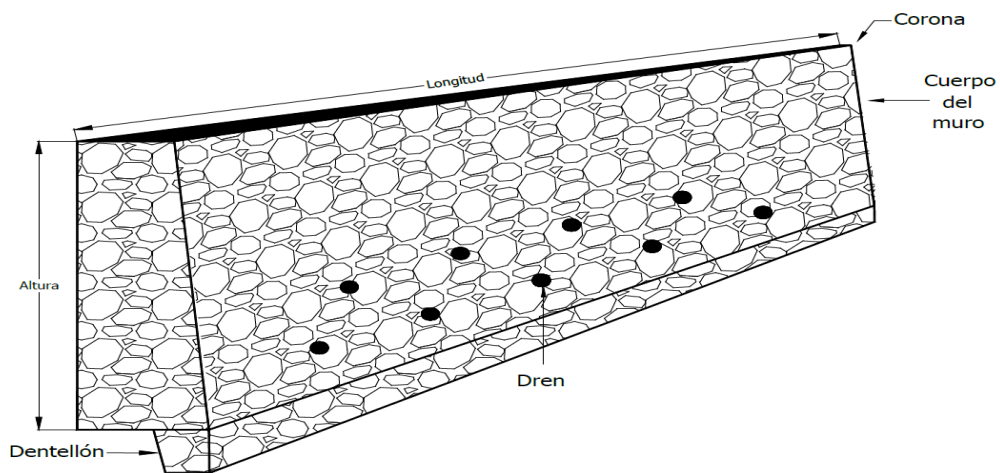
Muro de mampostería de piedra braza con drenes y dentellón, para sitios con riesgo de deslizamiento.
